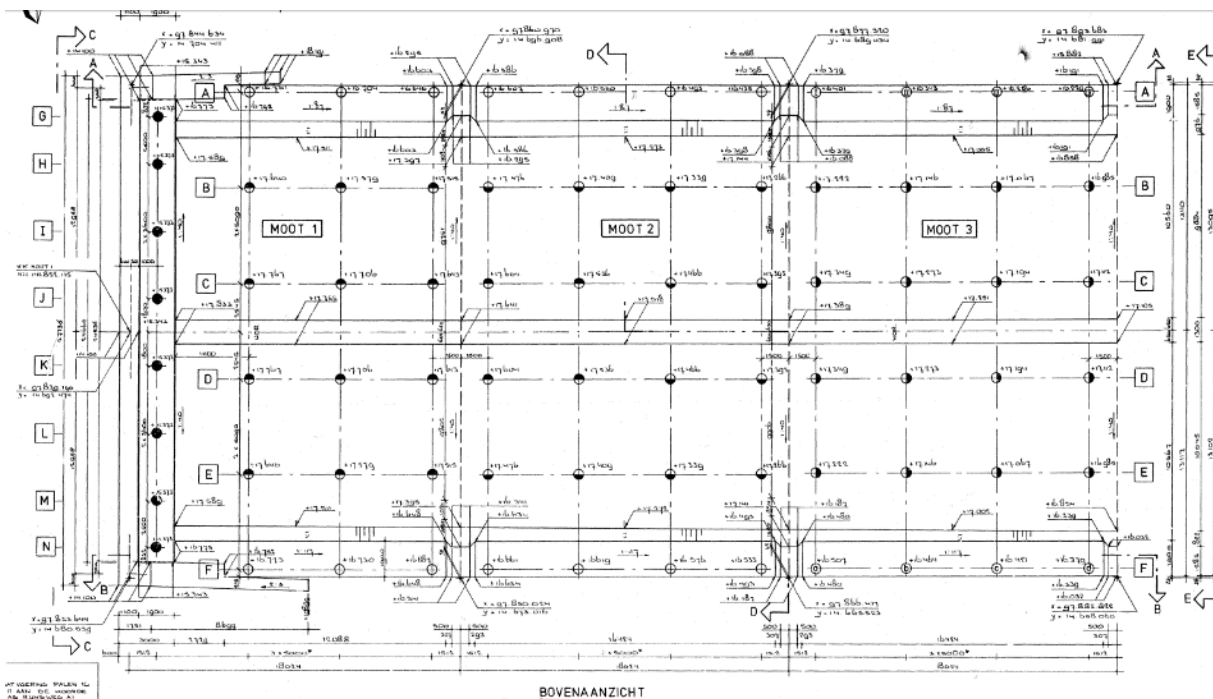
Bovenaanzicht westelijke toerit met verlengde betonnen bak en ingekorte folieconstructie (bron: tekening RWSON-2018-097942, RWSON-2018-097943 en RWSON-2018-097944).
